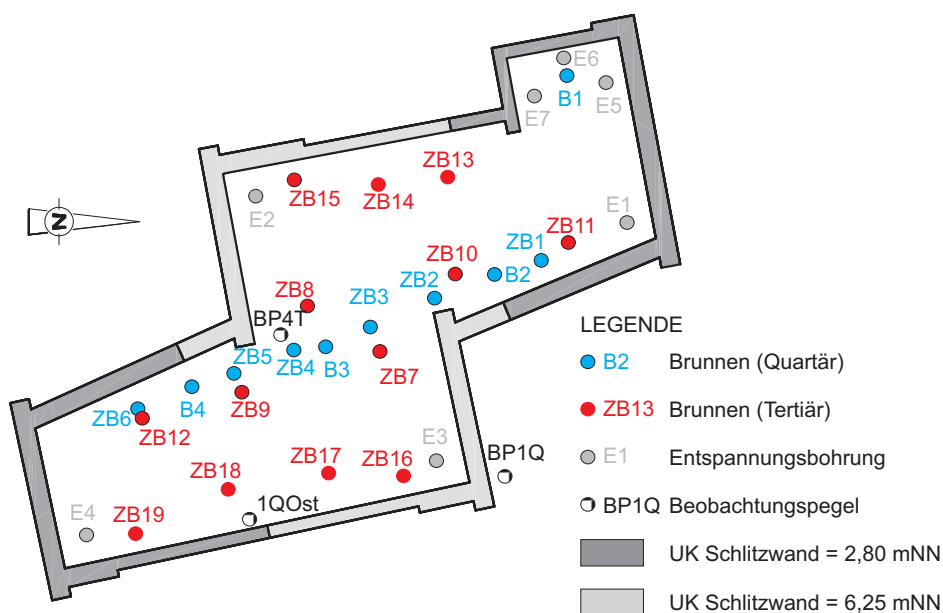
Wasserhaltungsanlage mit zusätzlichen Brunnen zur Reduzierung des Wasserdruckes unterhalb der abdichtenden Braunkohleschicht inkl. beispielhaft ausgewählter Beobachtungspegel
